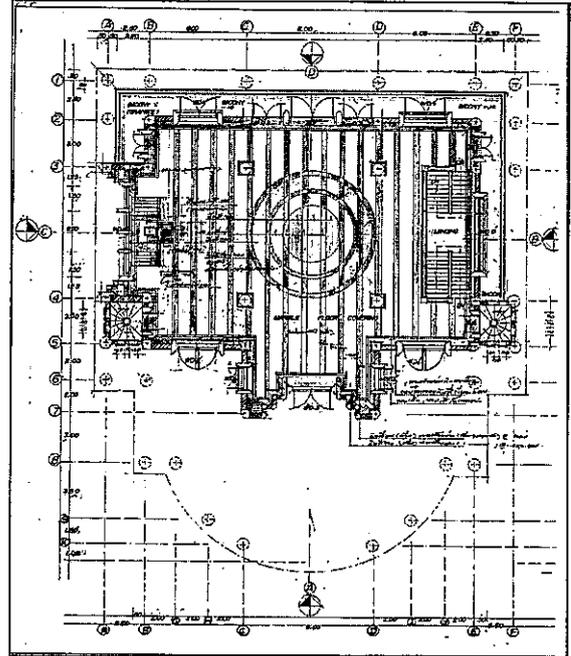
ชั้นล่าง (Ground Floor Plan)
